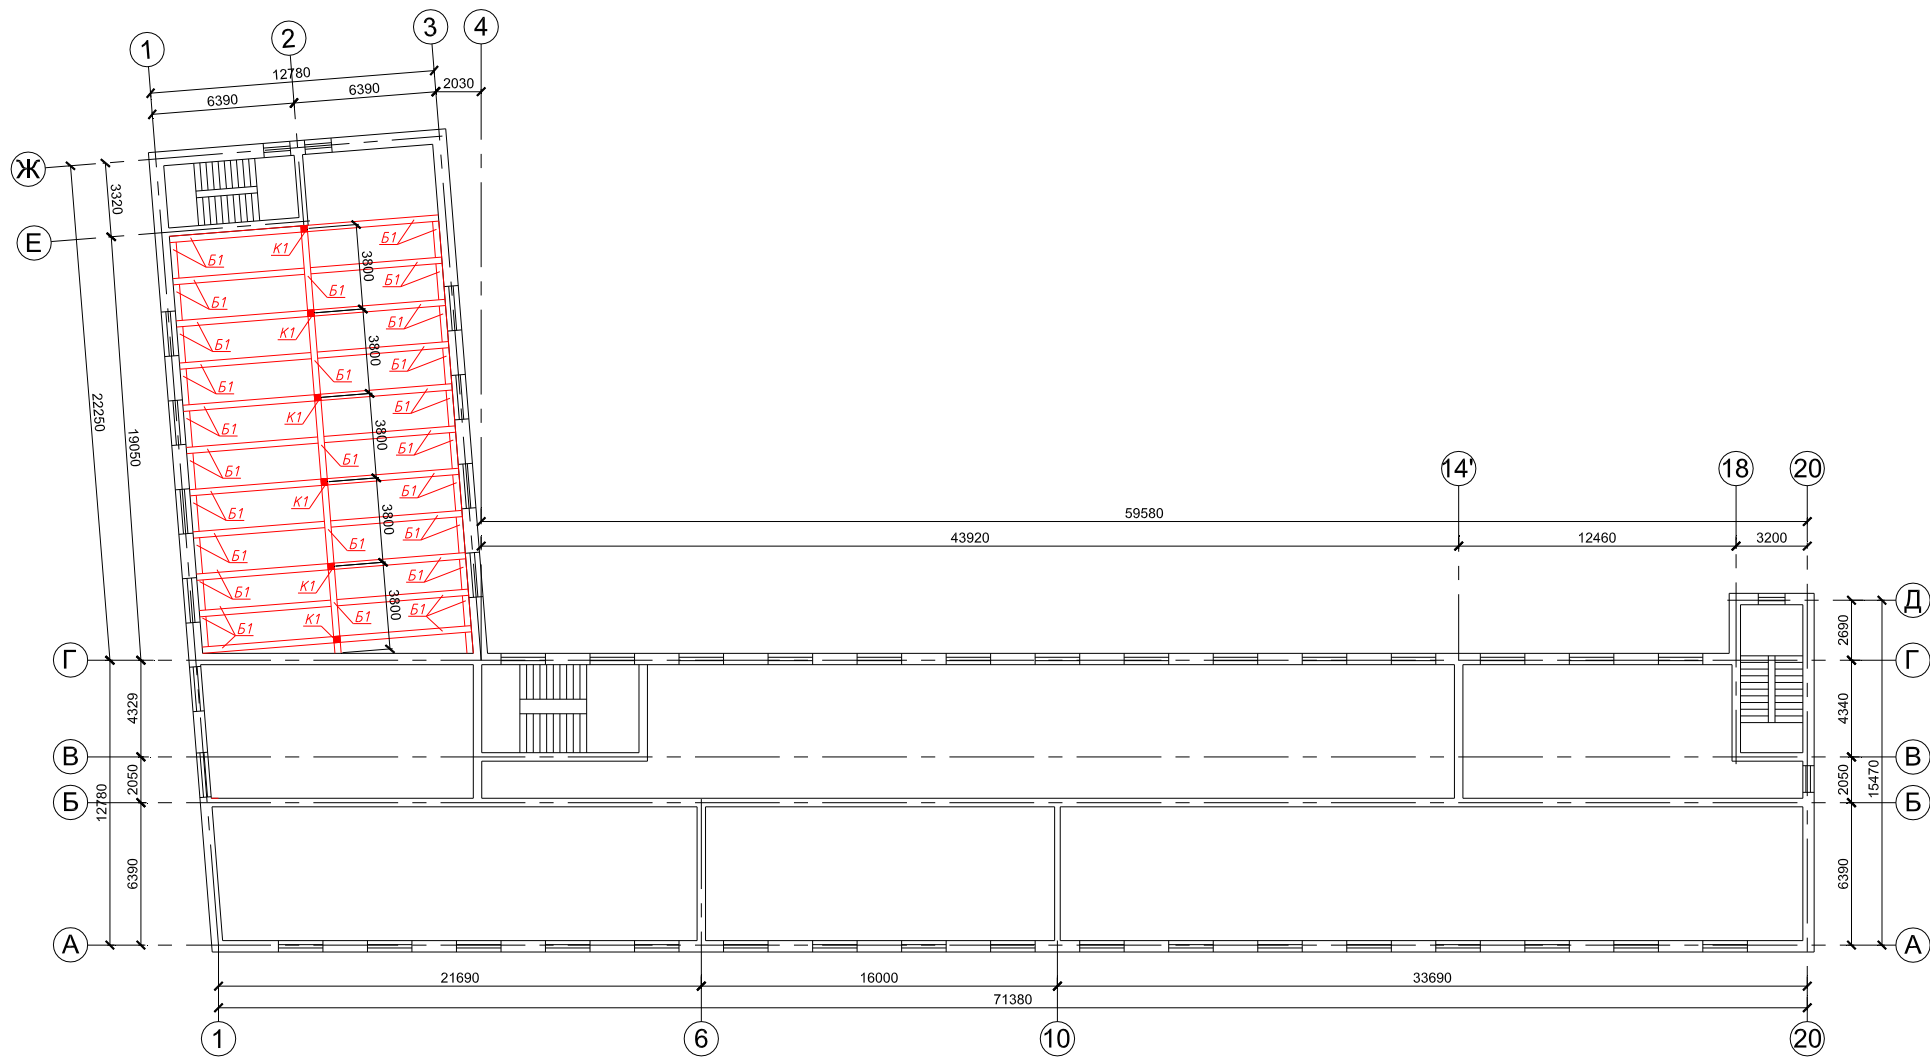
Схема раскладки плит перекрытия над третьим этажом здания.
